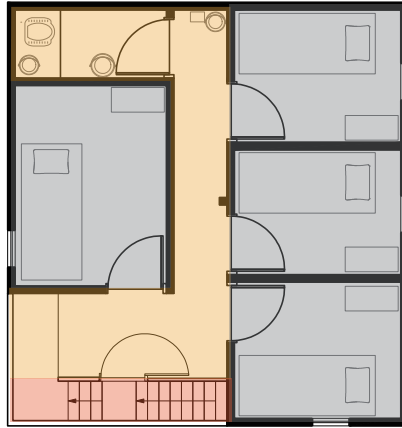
コス⑫; 家屋①の 3 階平面図 (1:50)
